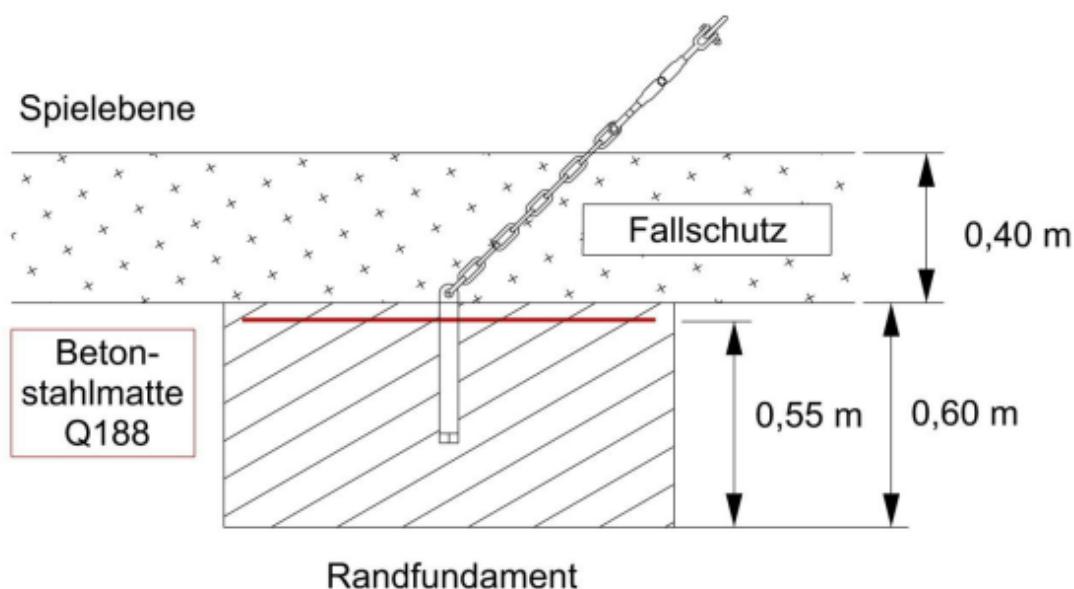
Struttura del fondamento perimetrale con rete d'armatura Q188
